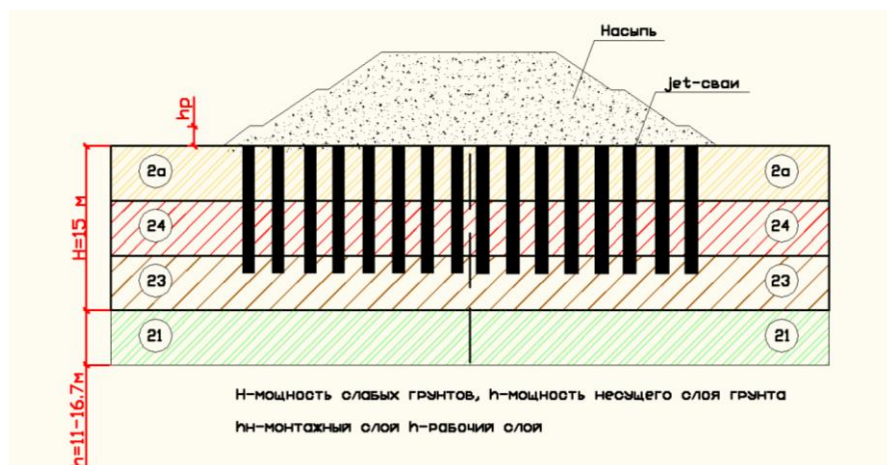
Устройство основания насыпи буронабивными сваями
